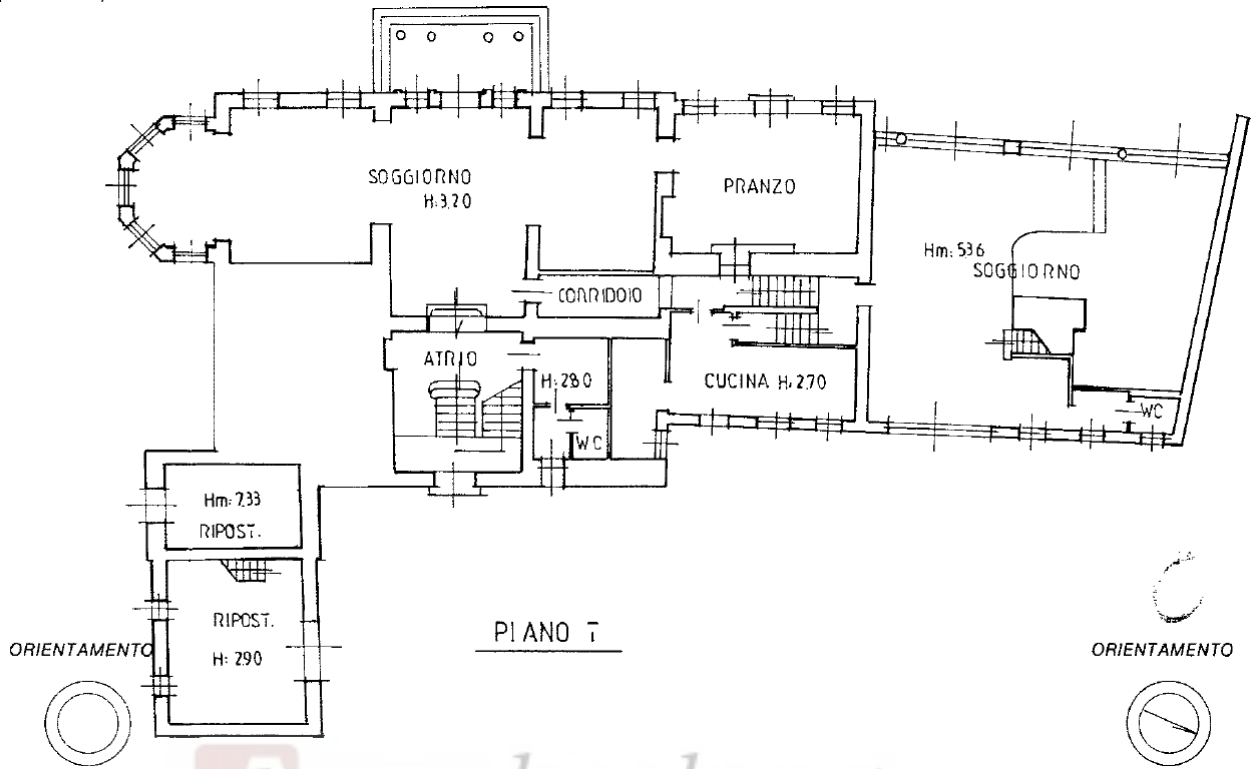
Estratto della planimetria catastale p.lla 415 (piano terra).
